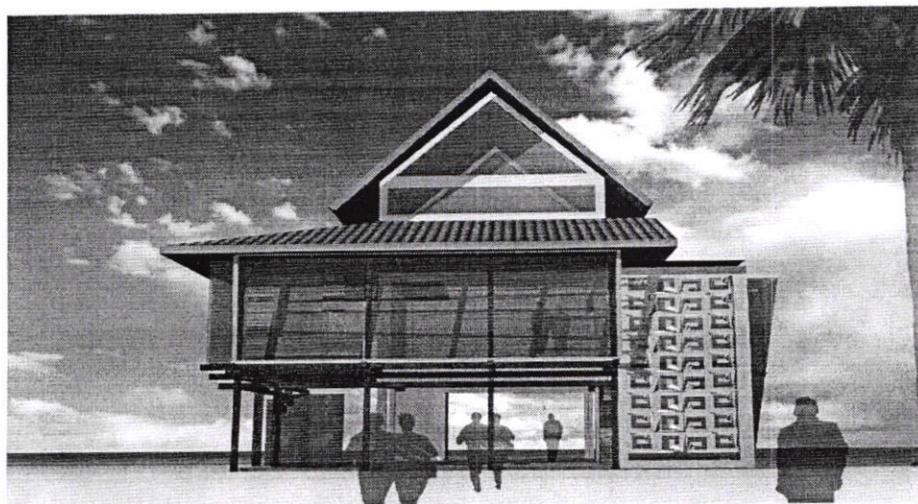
Salah satu contoh tipe panggung bangunan tradisional Lampung
